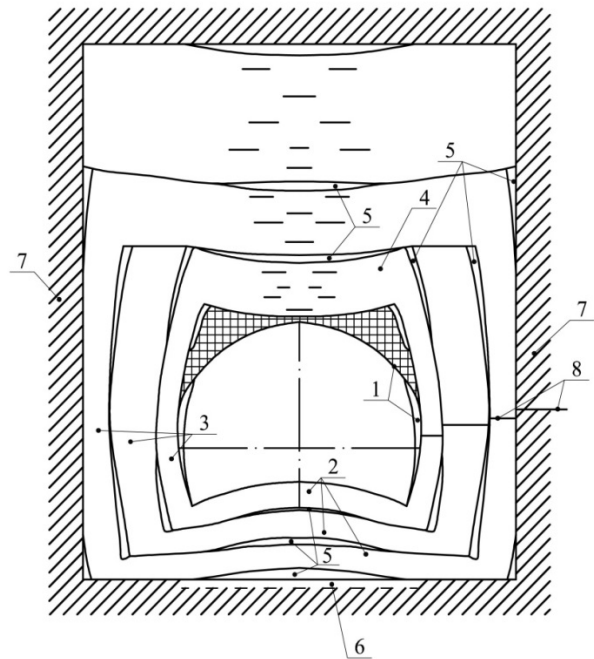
Схема деформирования (разрушения) пород приконтурного слоя и образования зон разрушения: 1- металлическая арочная податливая крепь; 2 – деформированные породы подошвы выработки; 3 – деформированные боковые породы; 4 – деформированные породы кровли; 5 – пустоты и трещины в деформированных (разрушенных) породах приконтурного слоя; 6 – вода; 7 – ненарушенный массив; 8 – маркирующий слой
